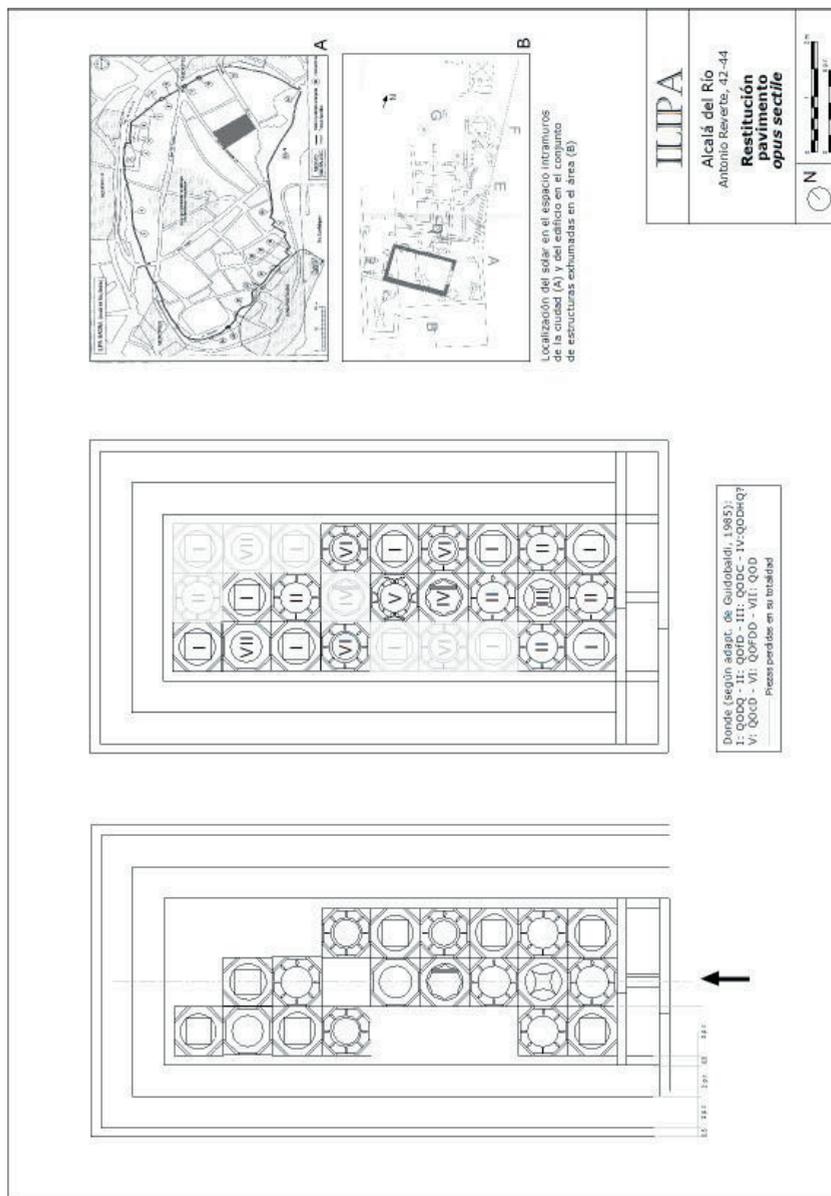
Ensayos de restitución del pavimento de *opus sectile*.
